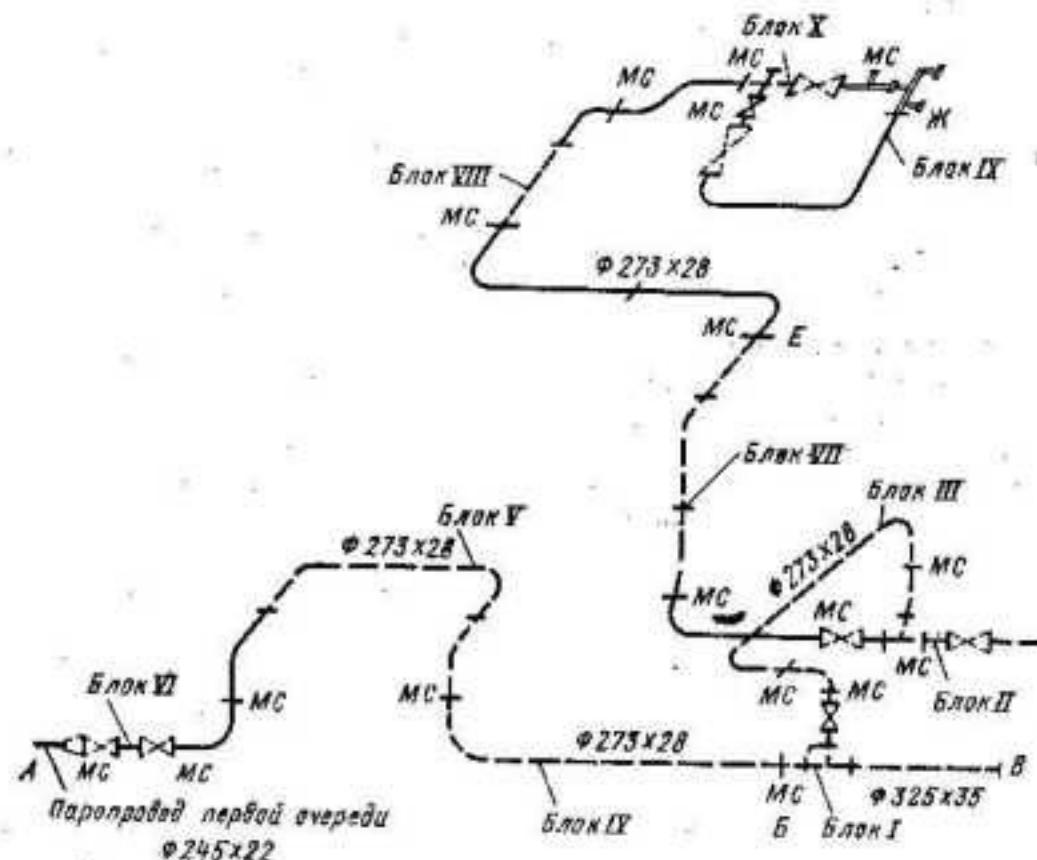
Схема трубопровода с указанием сварных монтажных стыков (MC). Трубопроводы, показанные на схеме пунктиром, монтируются блоками.
